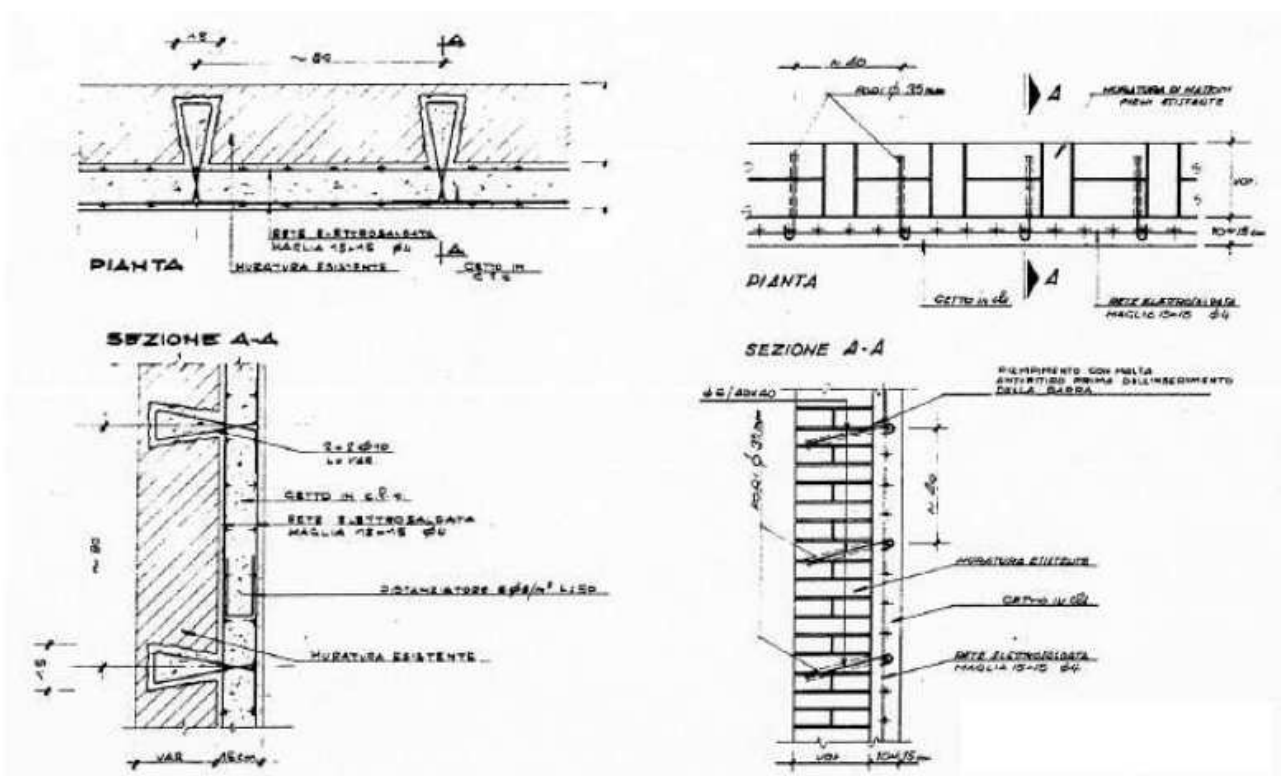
Particolare di collegamento di lastre in c.a. a muratura di mattoni esistente
